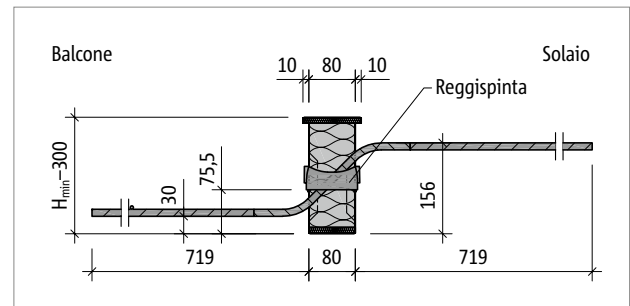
Schöck Isokorb® T tipo QL-V5 – QL-V6: sezione del prodotto
